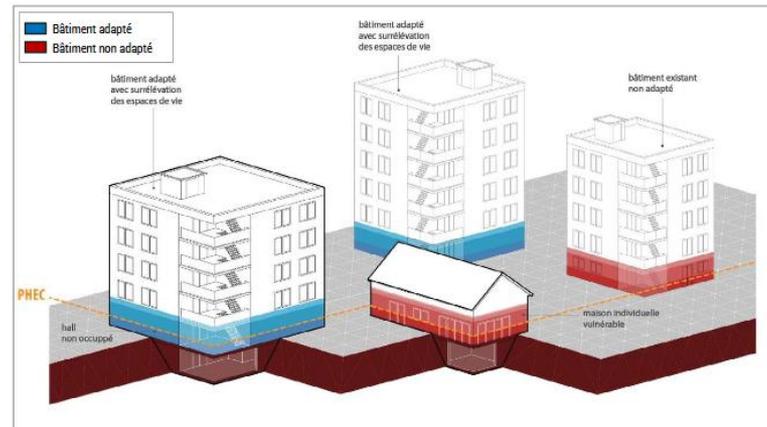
Principes architecturaux à valoriser pour les constructions en zones inondables
